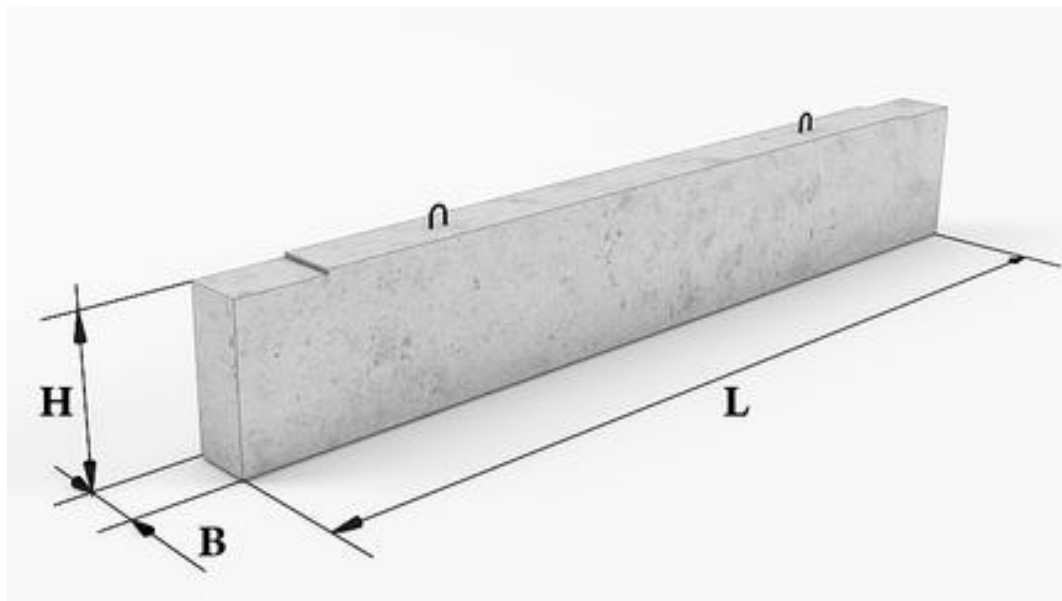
Прогон железобетонный ПРГ60.2.5-4АIII
